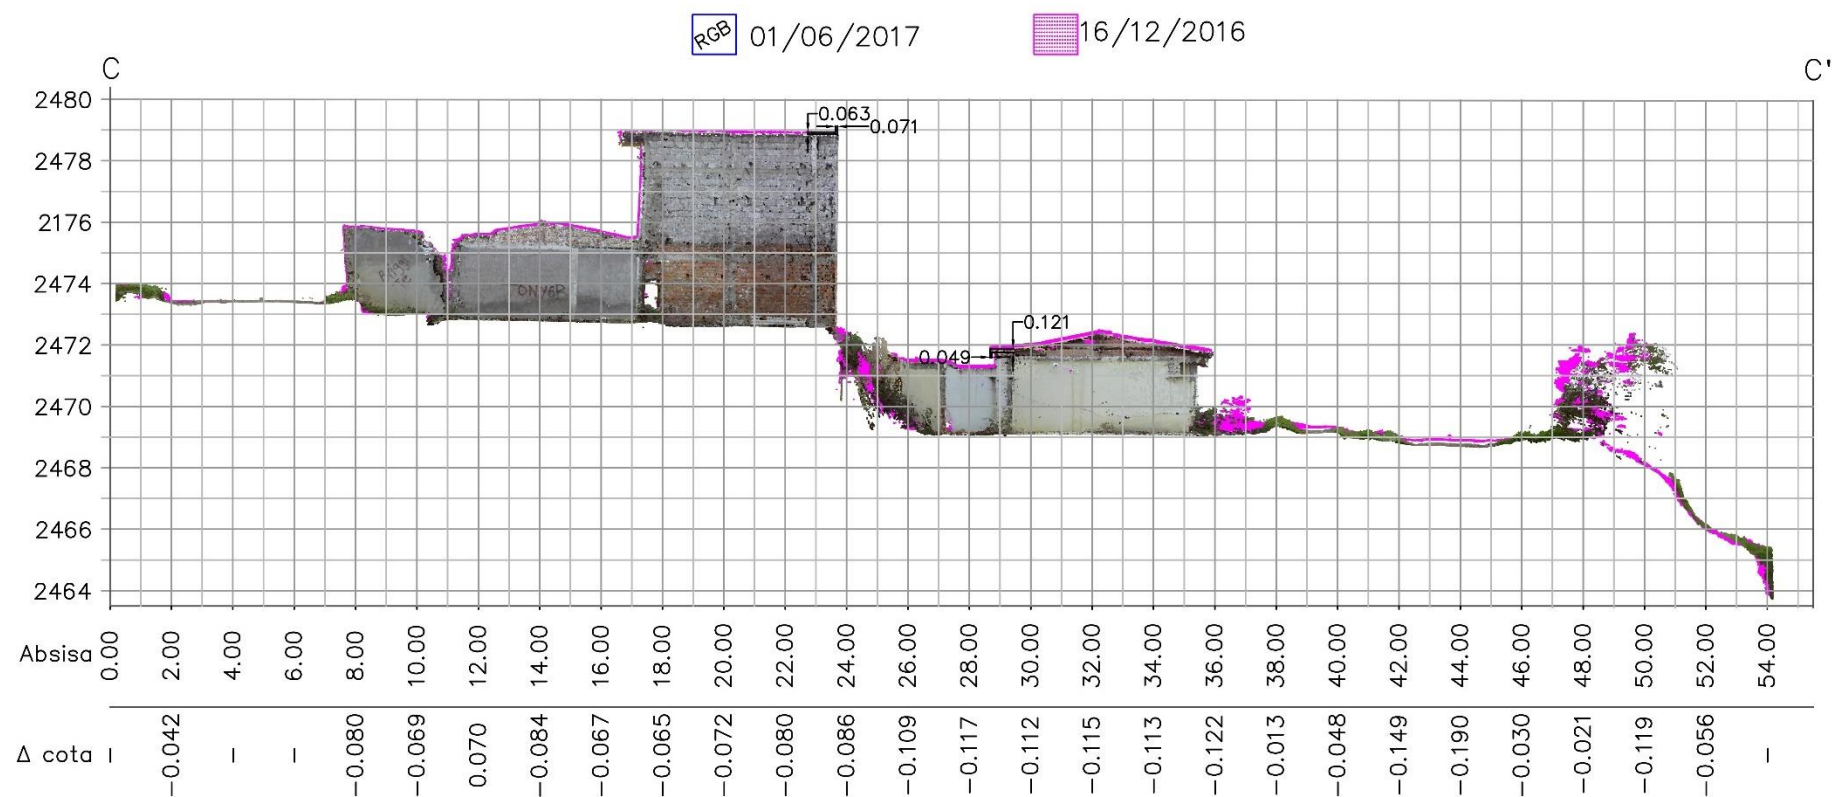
Levantamiento 1 vs levantamiento 2, perfil C-C'.
